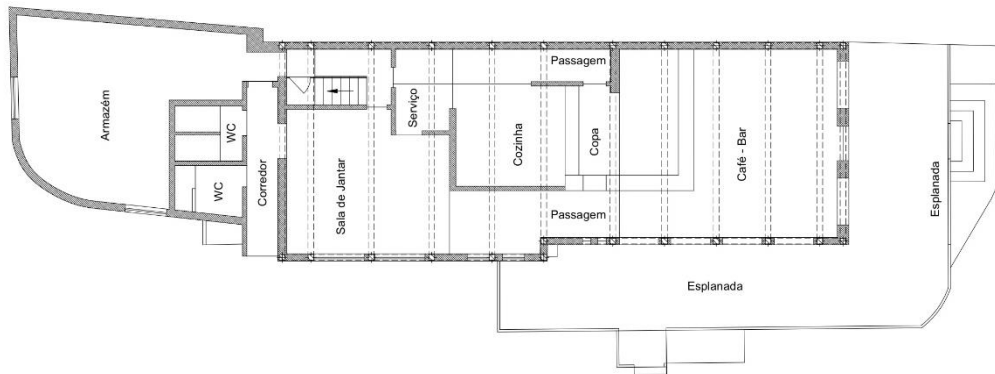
EXISTENTE | PLANTA DO R/C | S/ESCALA
